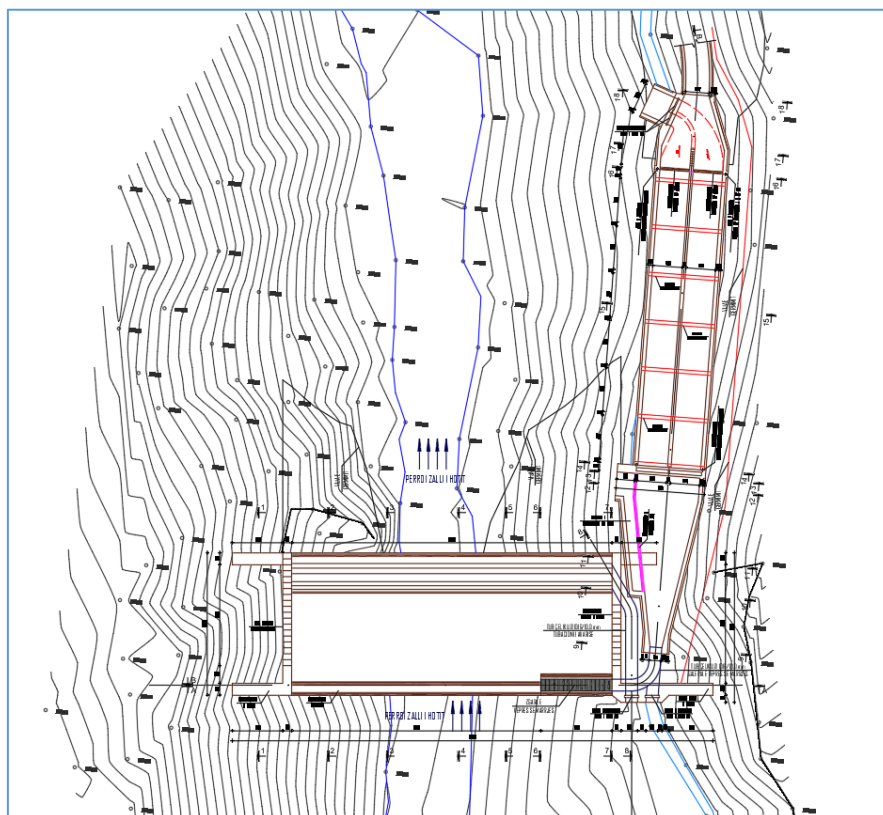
Planimetria e Veprës së Marrjes dhe Dekantuesit në përroin e Hotit
